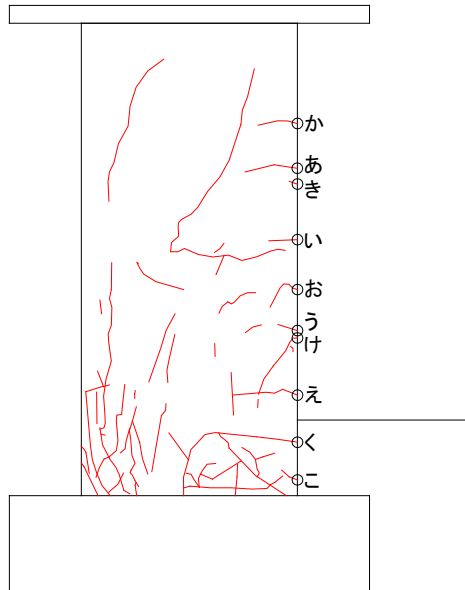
柱ひび割れ幅測定位置(試験体 A-6 負荷荷)
